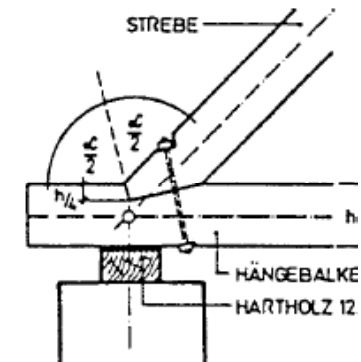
Einfaches Hängewerk, Doppeltes Hängewerk - Detailausführung (Detail A)
